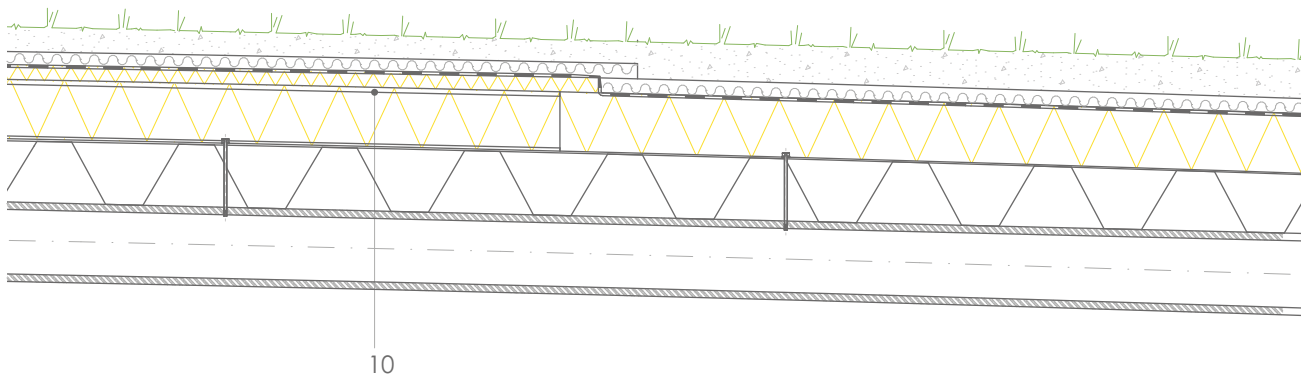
Detail 03 - Attika, Fassadenanschluß Dach/ M 1:20
